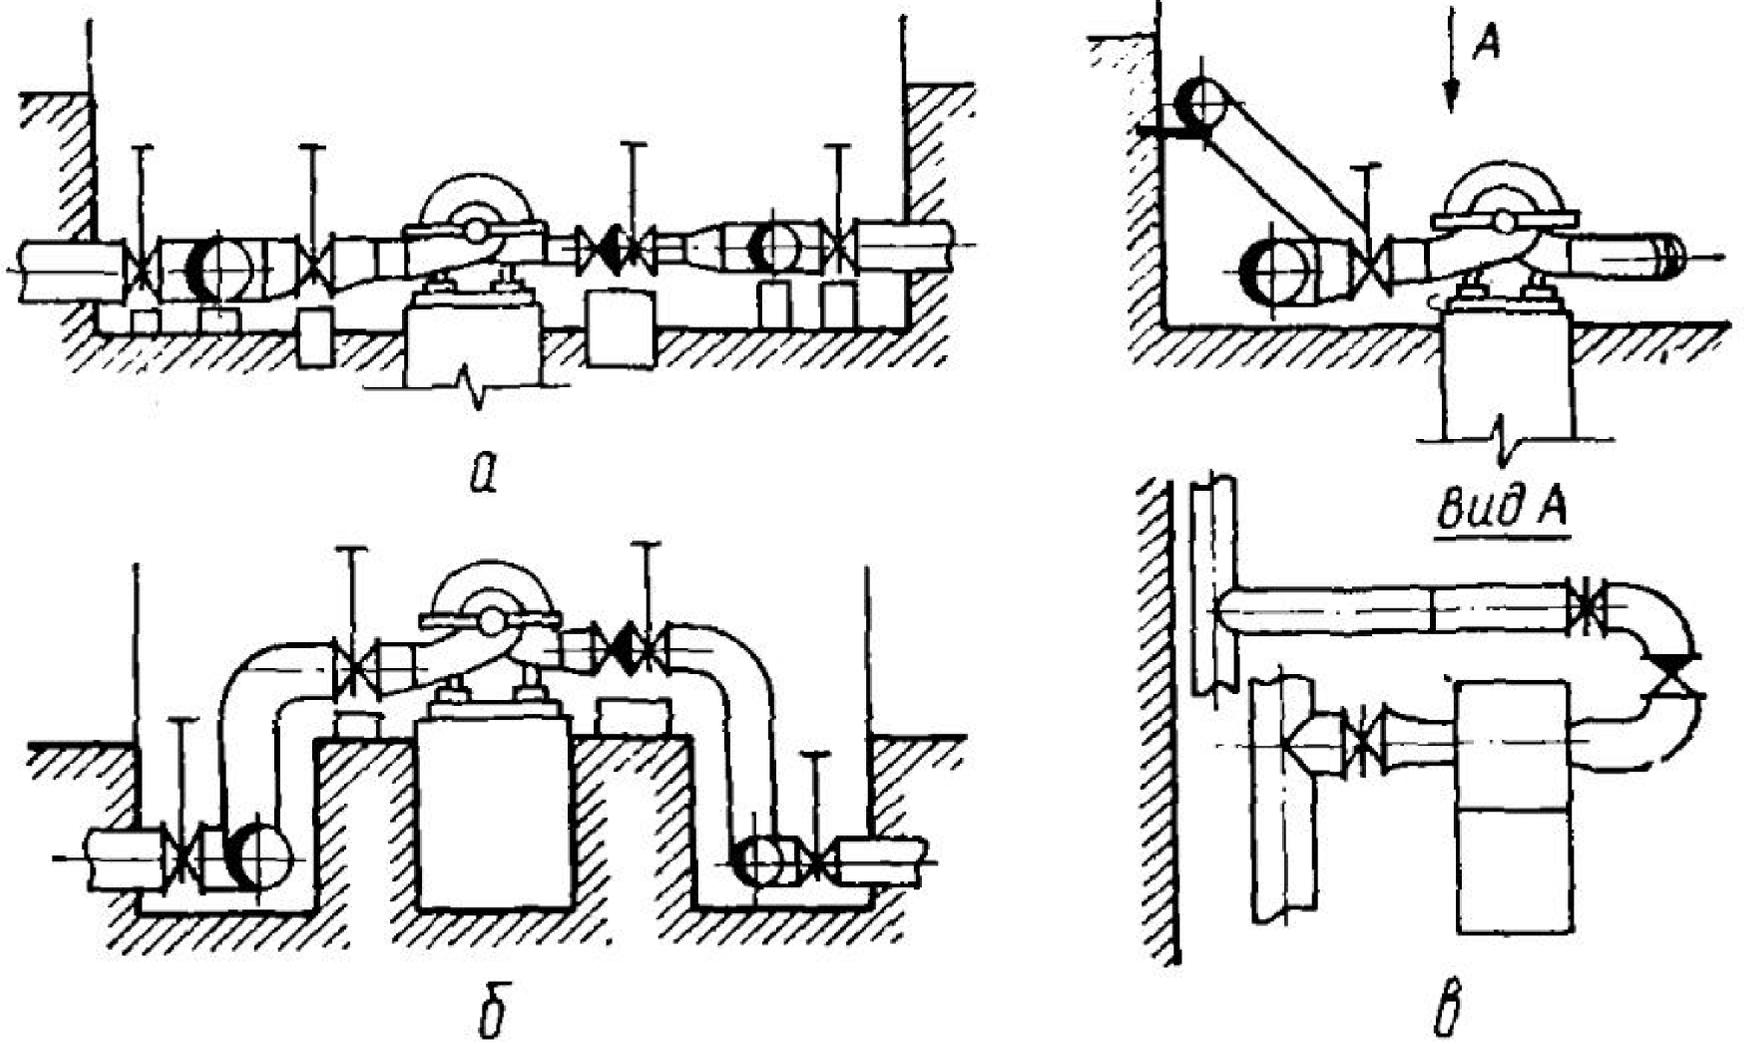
Основные схемы размещения трубопроводов на станциях II подъема:
